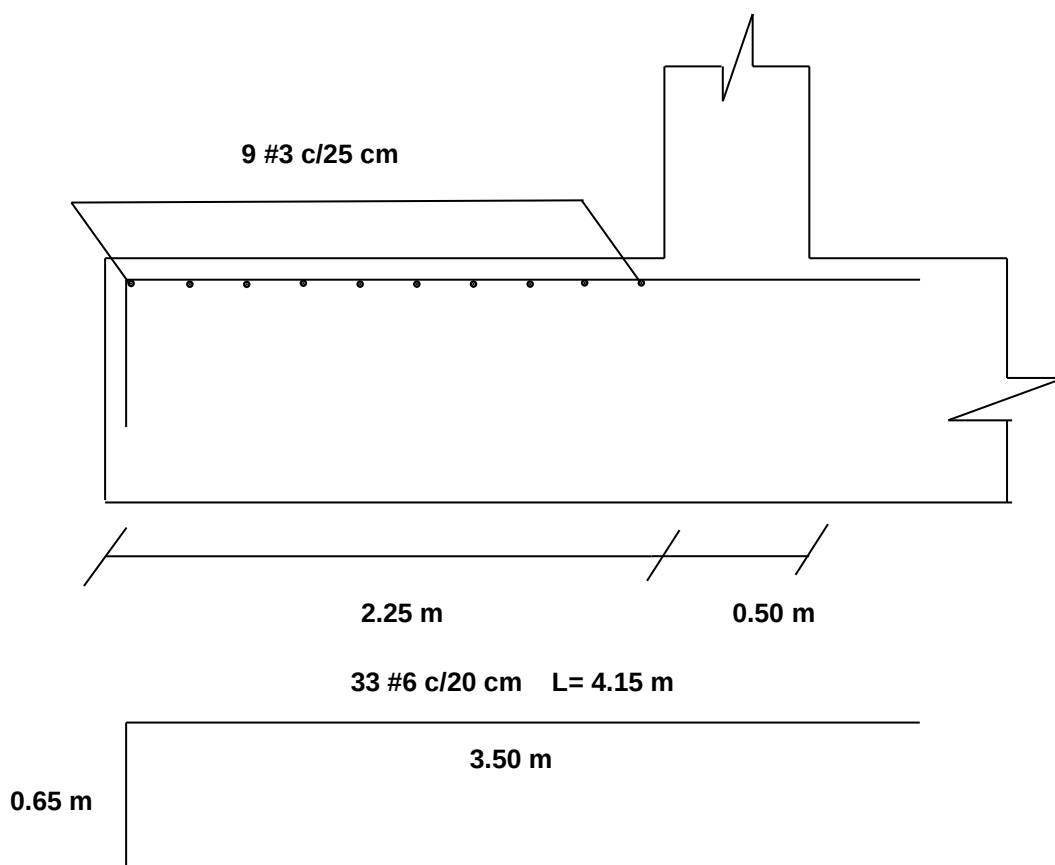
Armadura de la zapata correspondiente a los esfuerzos producidos en el talón de ésta.
